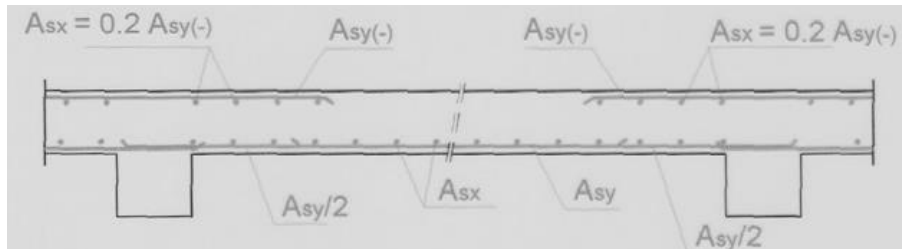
Armadura inferior e superior numa laje contínua – corte transversal
